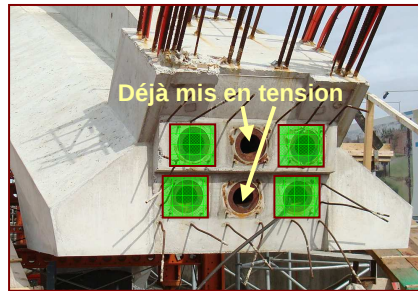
Plaques d'ancrage d'appui / Support anchorage plate
